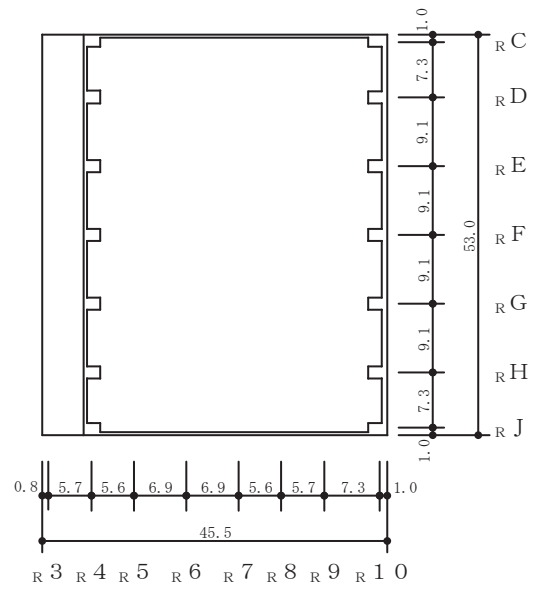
(5) 原子炉建屋の概略平面図 (0.P. 22.5m)
